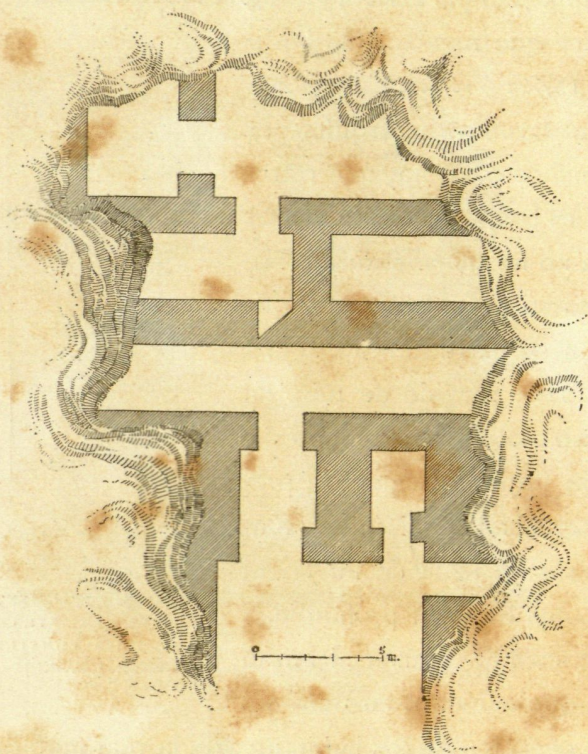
PLANTA DE ALGUNAS CÁMARAS DE UN PALACIO DESCUBIERTO EN MUGHEIR (SEGÚN TAYLOR)
